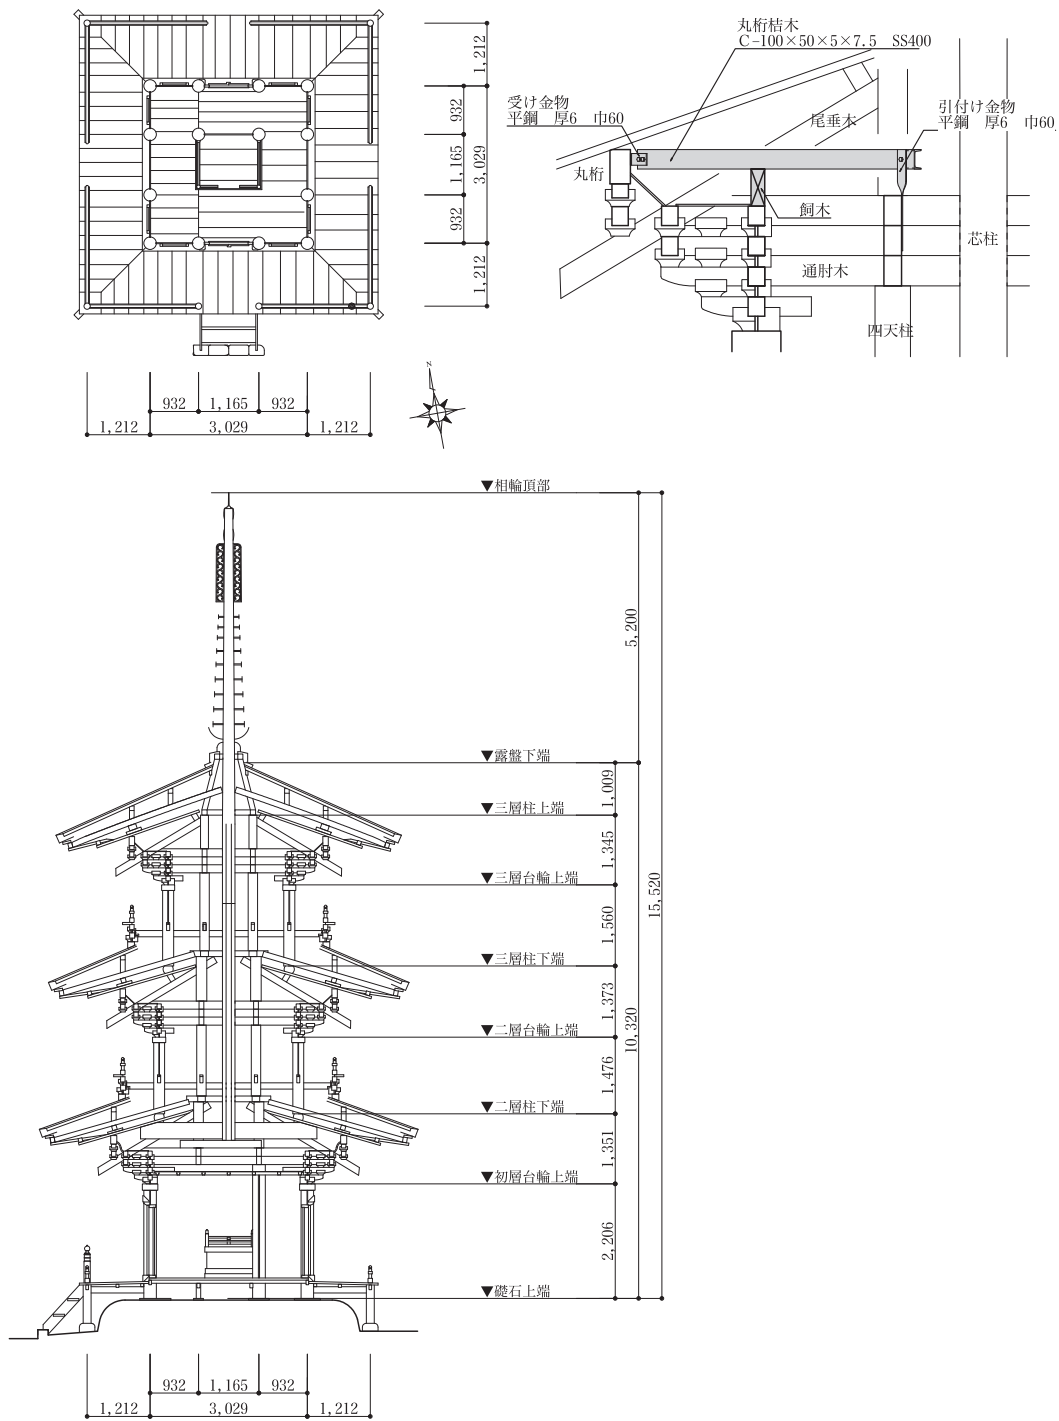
德源院三重塔 初層平面図、丸桁桔木概要図、断面図
